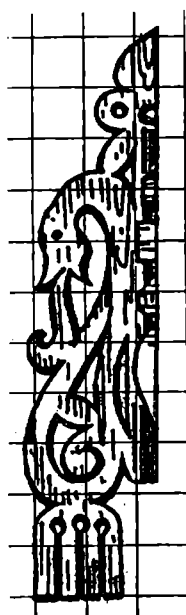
Шаблоны для изготовления прорезной и накладной резьбы:
